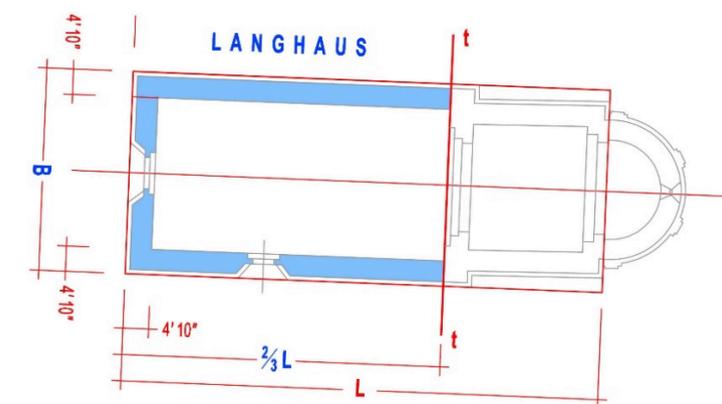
Pfarrkirche Schöngrabern, Rekonstruktion Grundriss Langhaus
